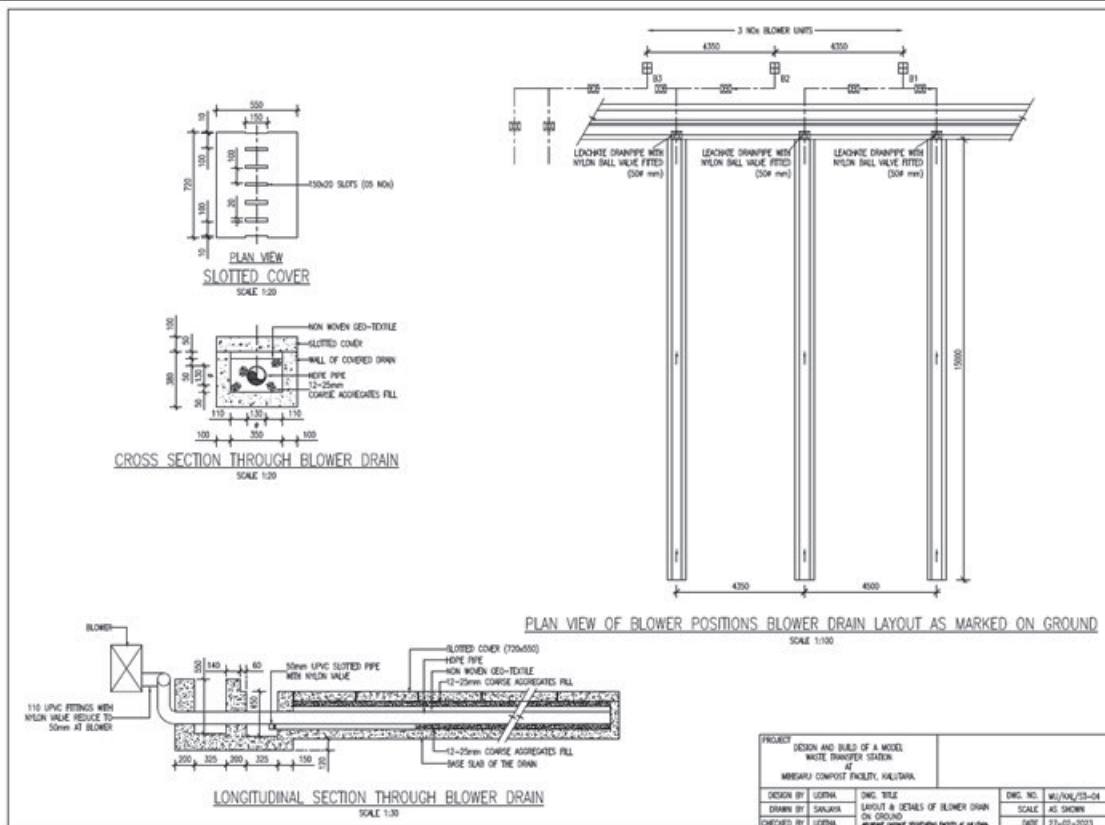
エアレーション促進システムの配置図、平面図、断面図
